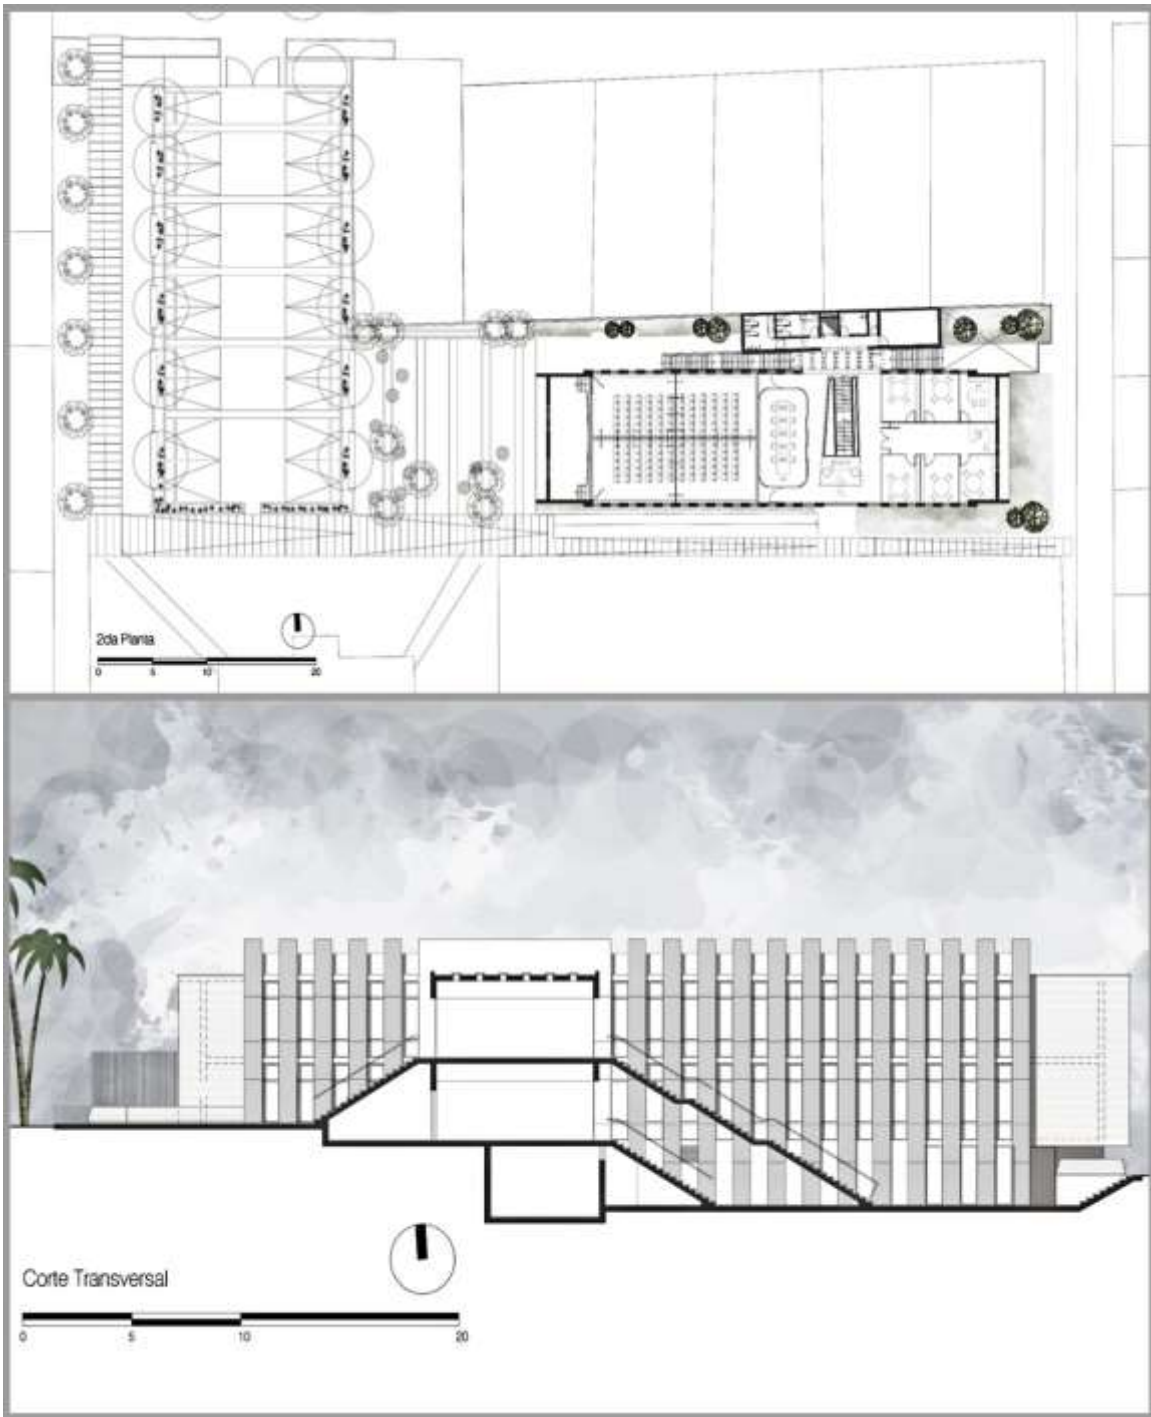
2da Planta y corte de la Plaza Biblioteca la Molina
